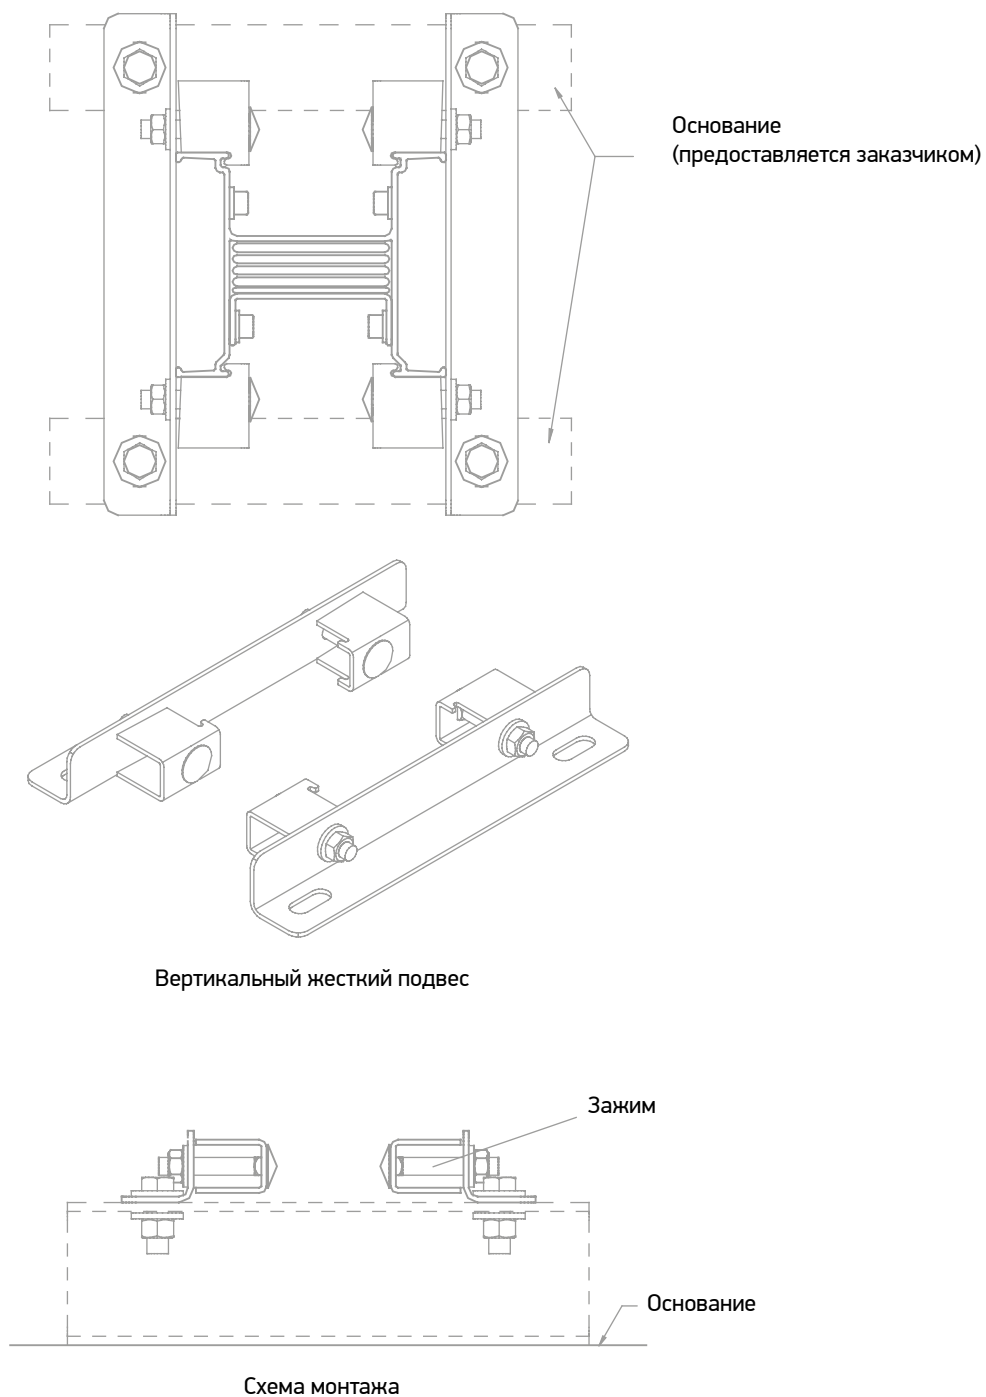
Монтаж с использованием вертикального жесткого подвеса
